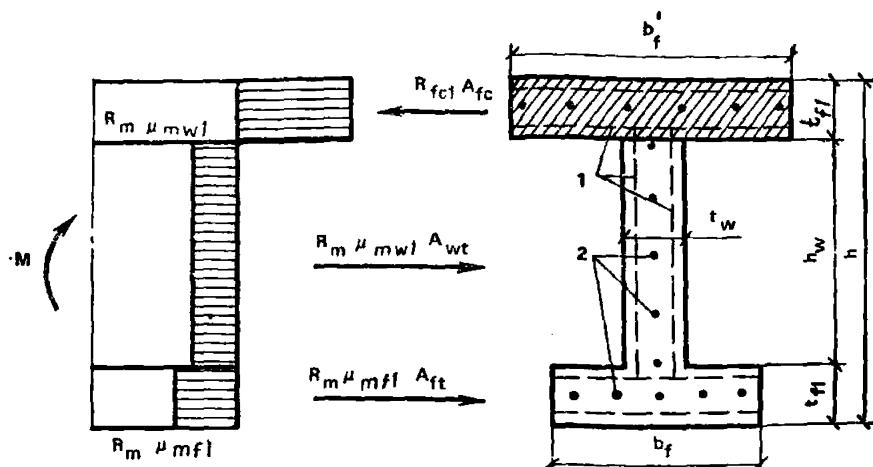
Схема усилий и эпюра напряжений в изгибаемых элементах двутаврового сечения при $x \leq l_f'$
